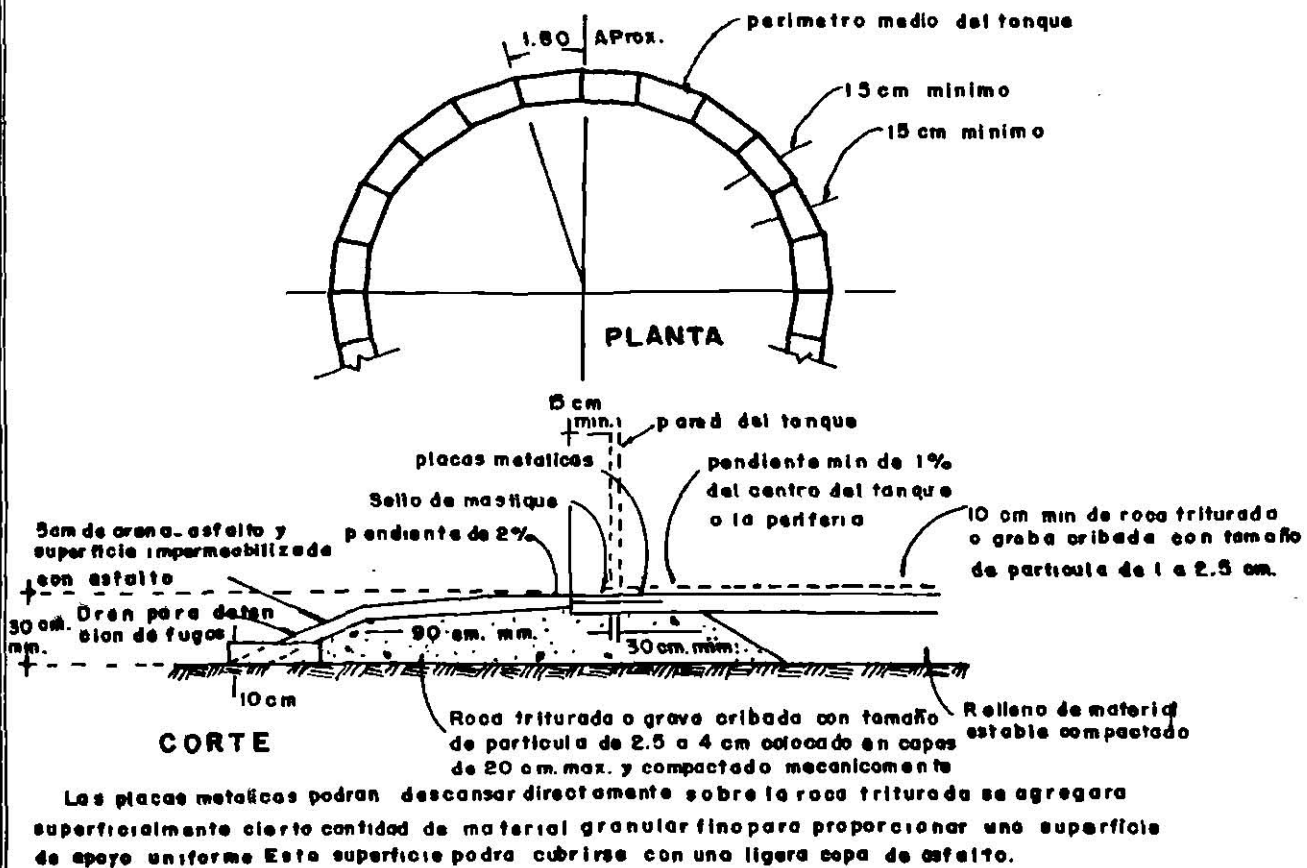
CIMENTACION SOBRE ZAPATA DE GRAVA ROCA TRITURADA
